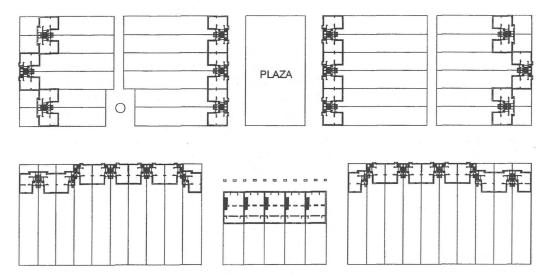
Planta parcial del barrio de sant cugat (dibujo de Ramón Ripoll)
